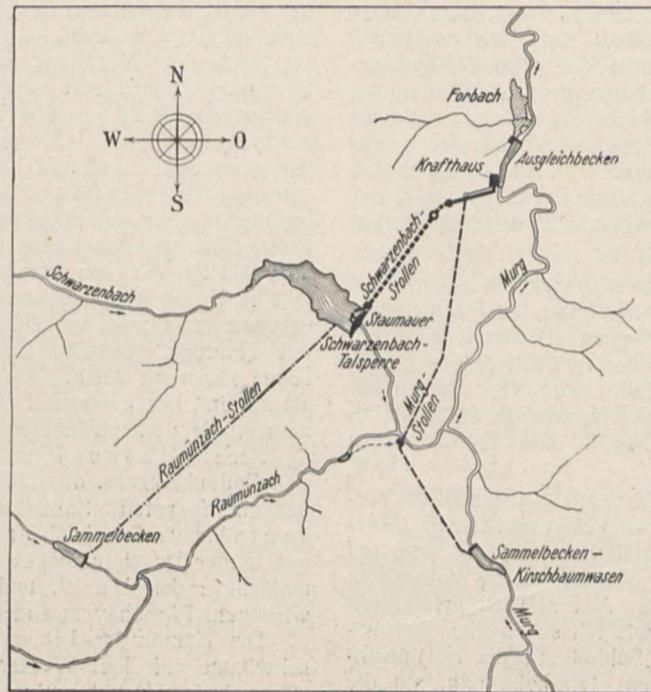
Plan des Murgwerks nach dem zweiten Ausbau.
